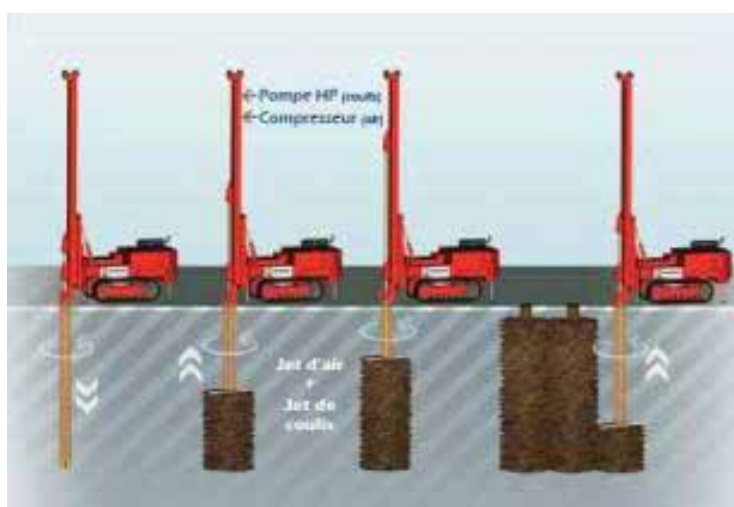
Schema di funzionamento di un impianto a Jet-grouting
